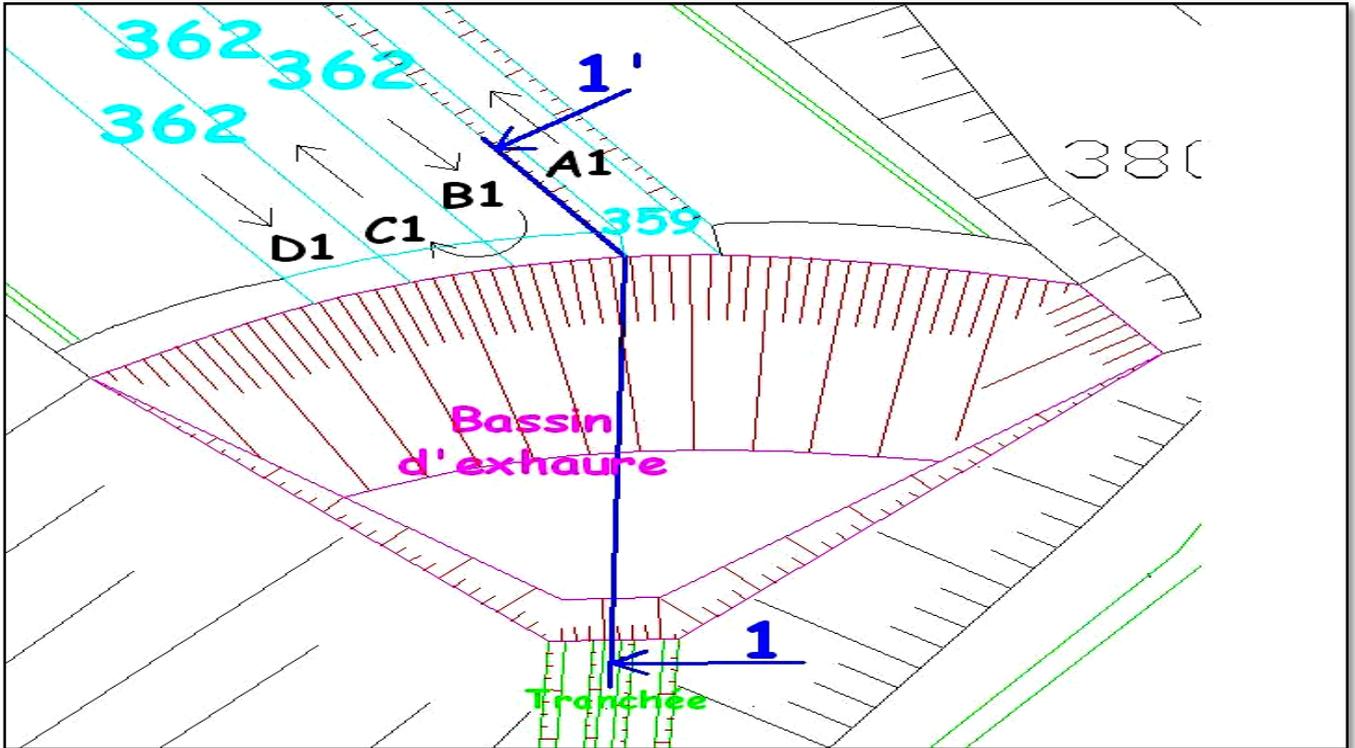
Vue en plan de la tranchée, le bassin et les planchers d'exploitation. (AUTO CAD 2008)
